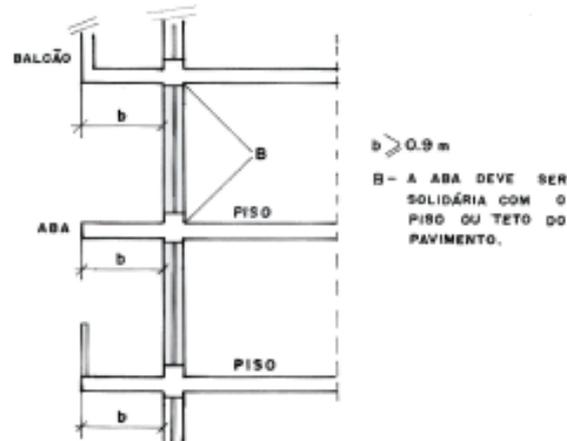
Compartimentação vertical – projeção da laje – Esquema em corte da fachada
